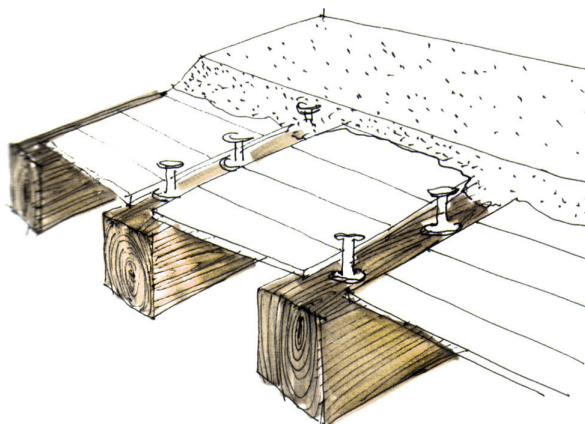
Reforço com recurso a elementos de betão armado: utilização de lajeta armada de betão sobre pavimento preexistente
